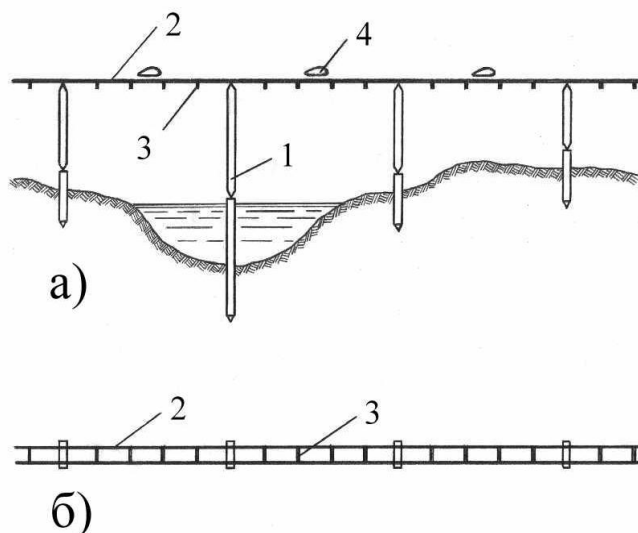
Схема размещения поперечных планок по длине трассы:
